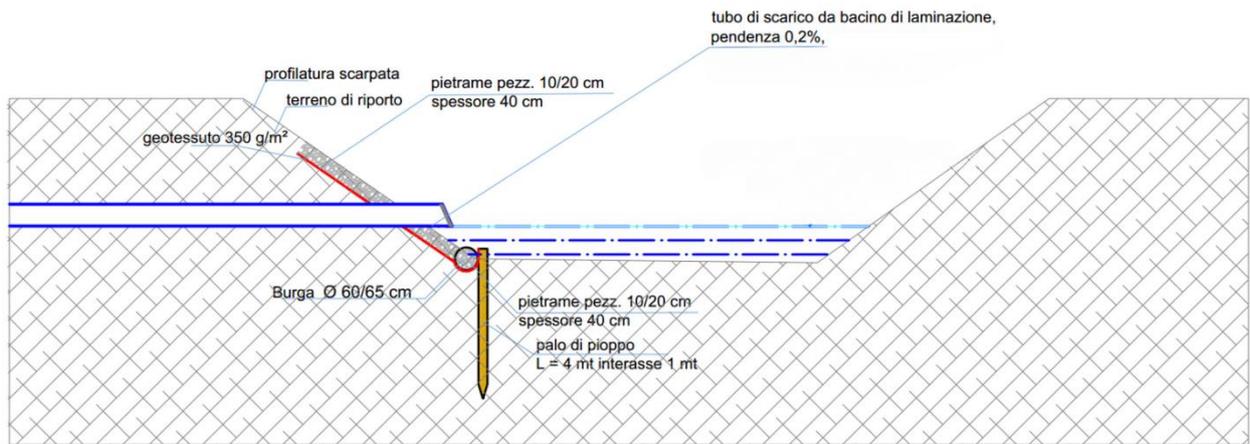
Sezione tipologica punto scarico e protezione spondale
